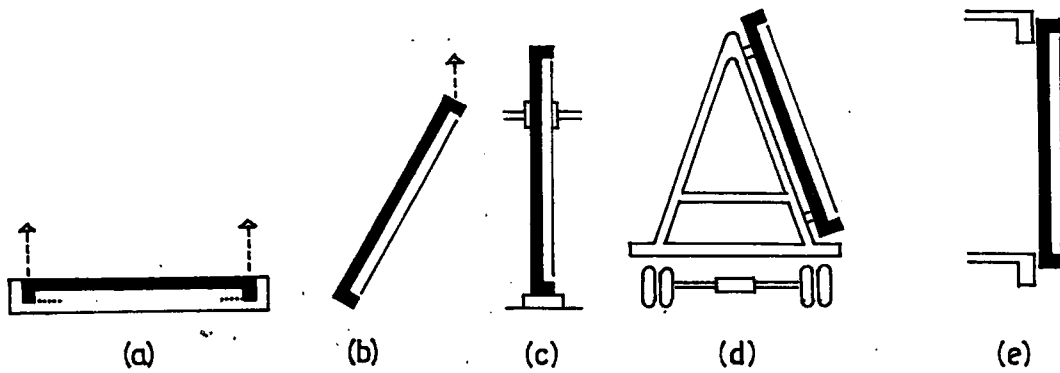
Beton Esaslı (Ağır) Gıydirme Cephe
